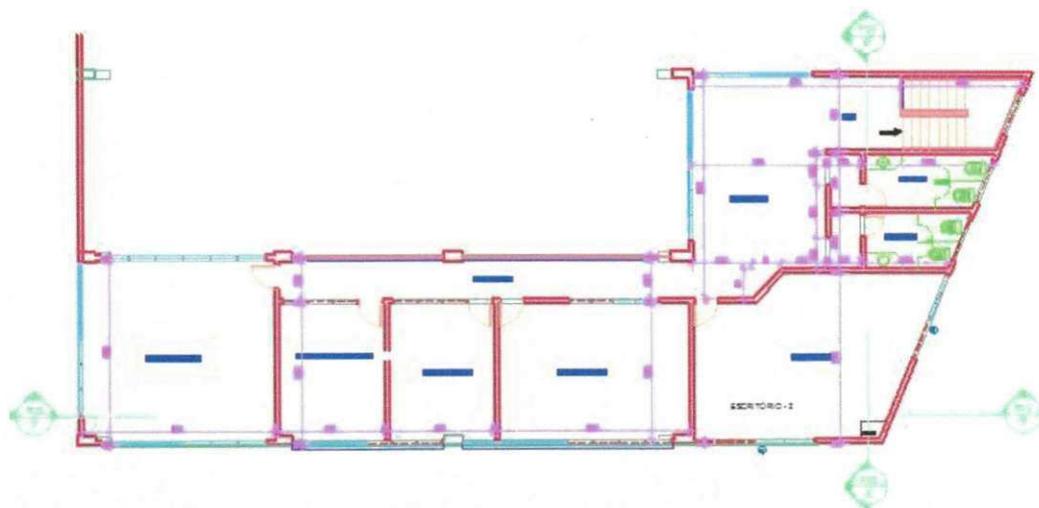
Planta baixa 1º pavimento dos escritórios.
